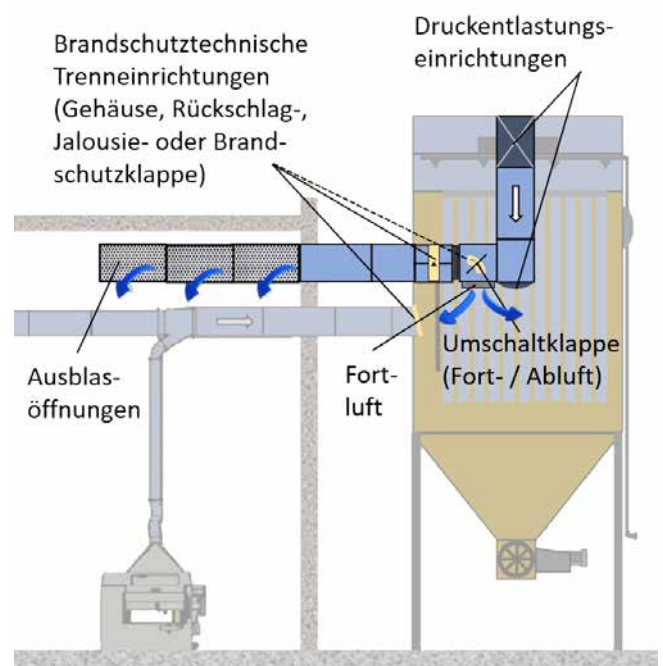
Reinlufrückführung mit Einrichtungen zur Fortluft- und Rückluftführung
